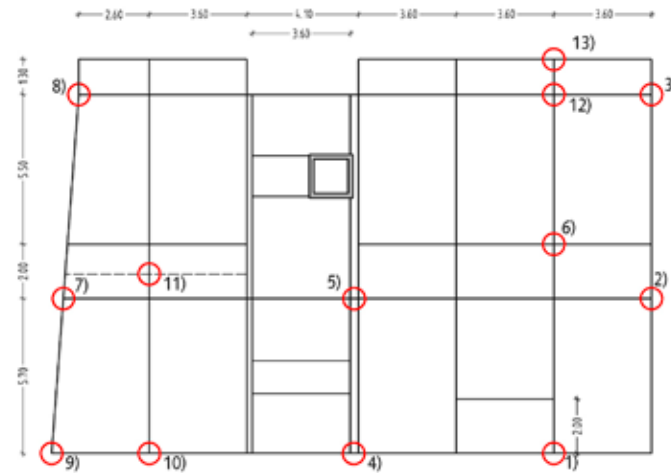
Position Anschlussdetails im Grundriss [m]
